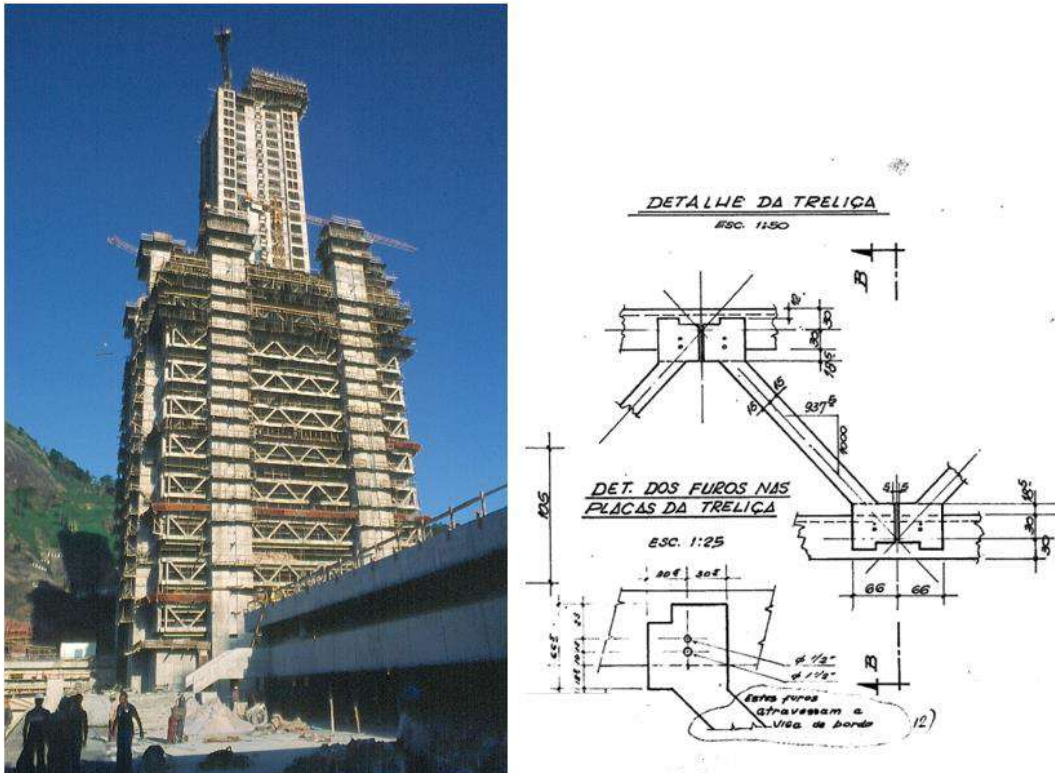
Torre Rio Sul. À esquerda: fase da construção.
